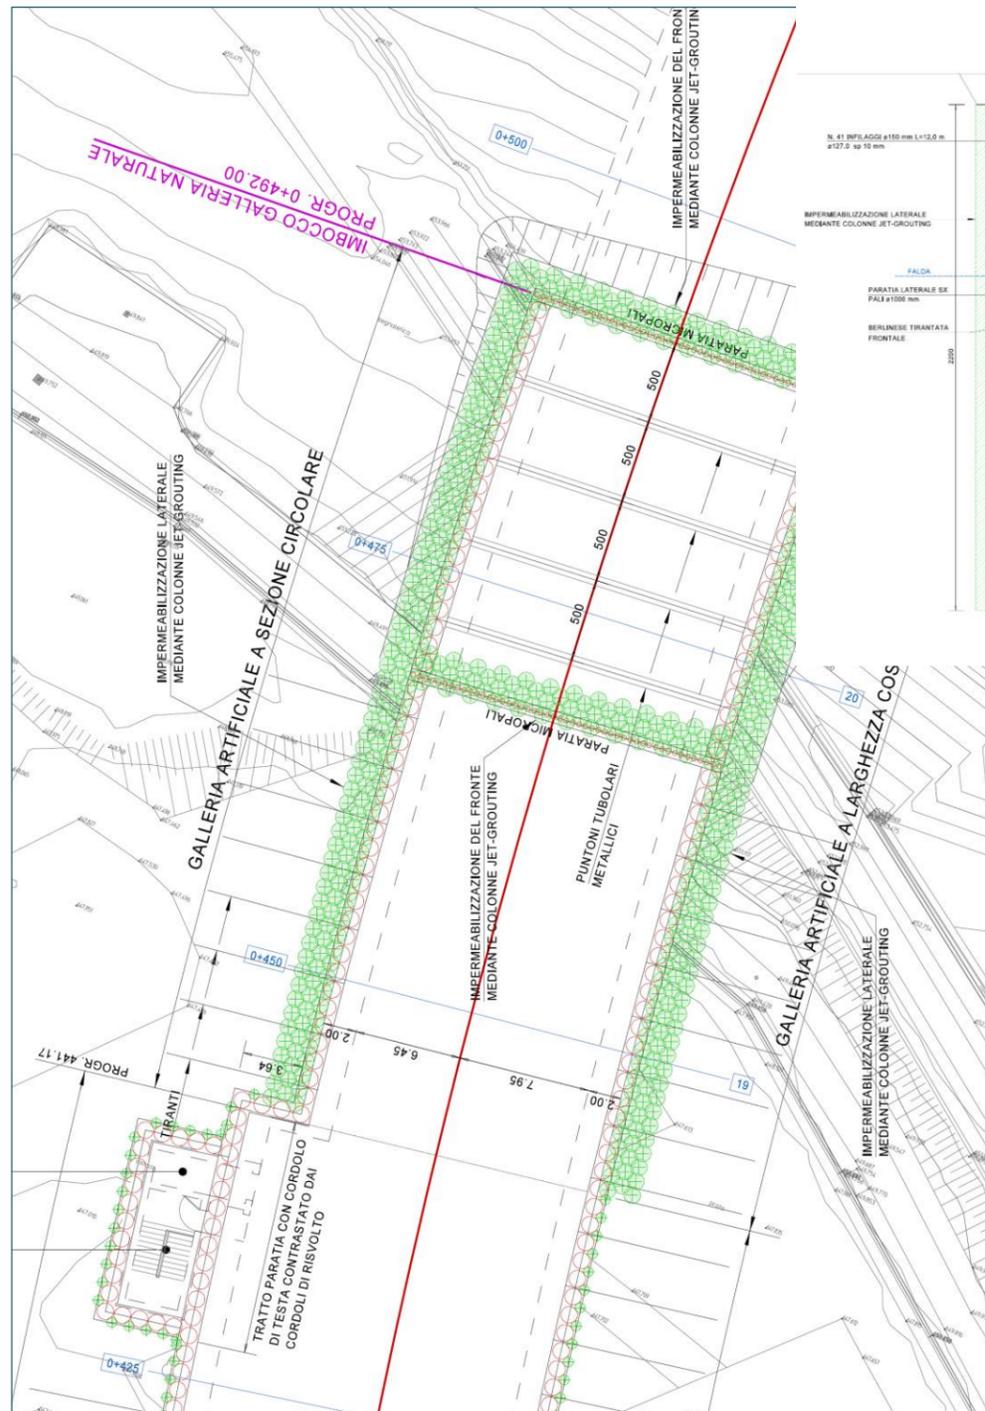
Galleria naturale – Stralcio planimetrico imbocco Sud
